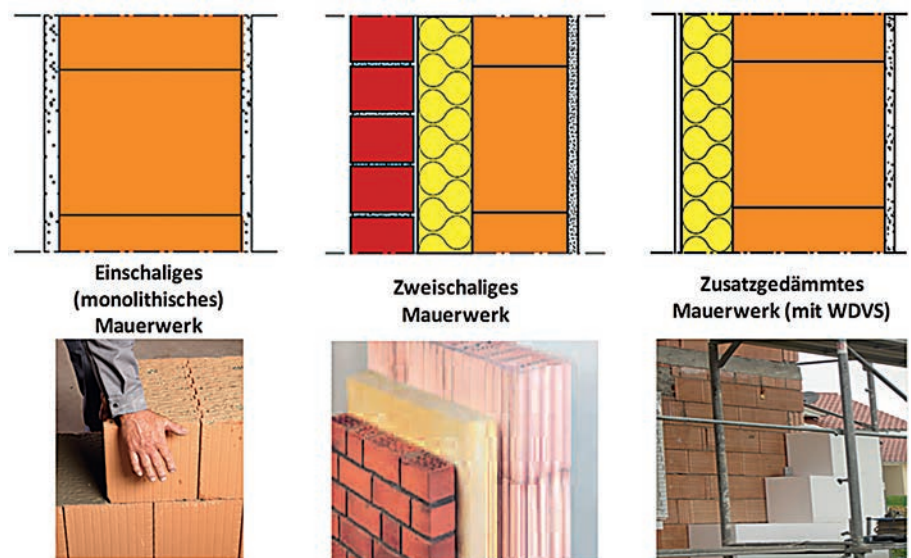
Typische Außenwandkonstruktionen aus Mauerwerk
